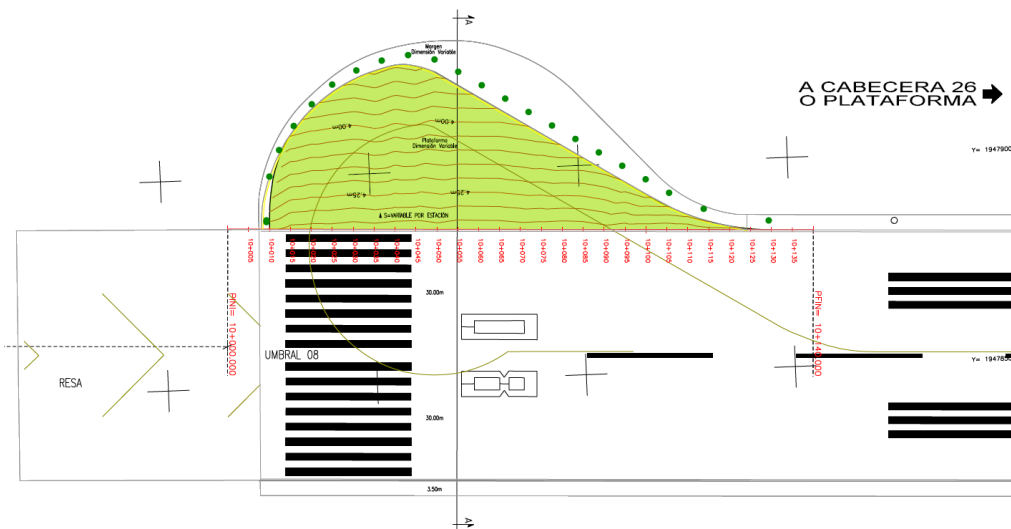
Planta General Reestructuración de Plataforma de Viraje 08⁸.
